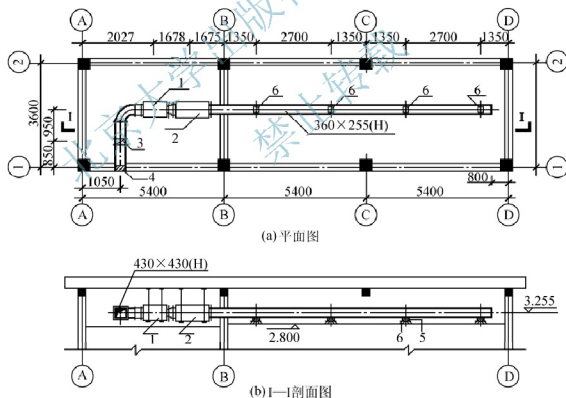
某单位办公室舒适性空调工程平面图及剖面图
